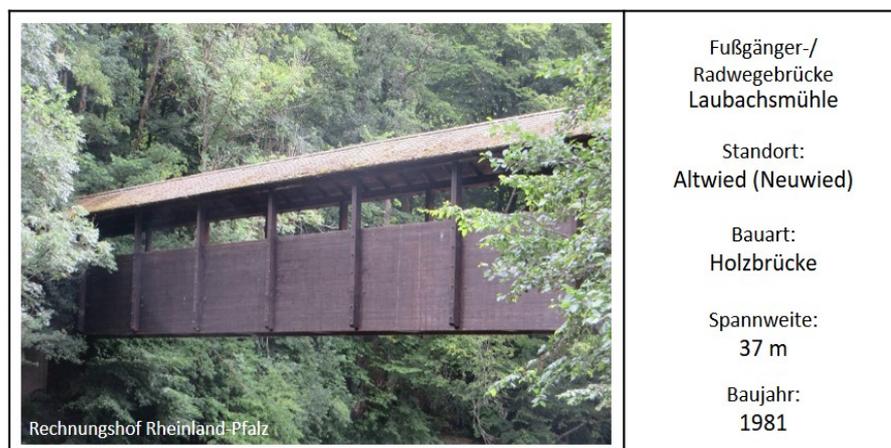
Geschützte Holzbrücke mit Überdachung
